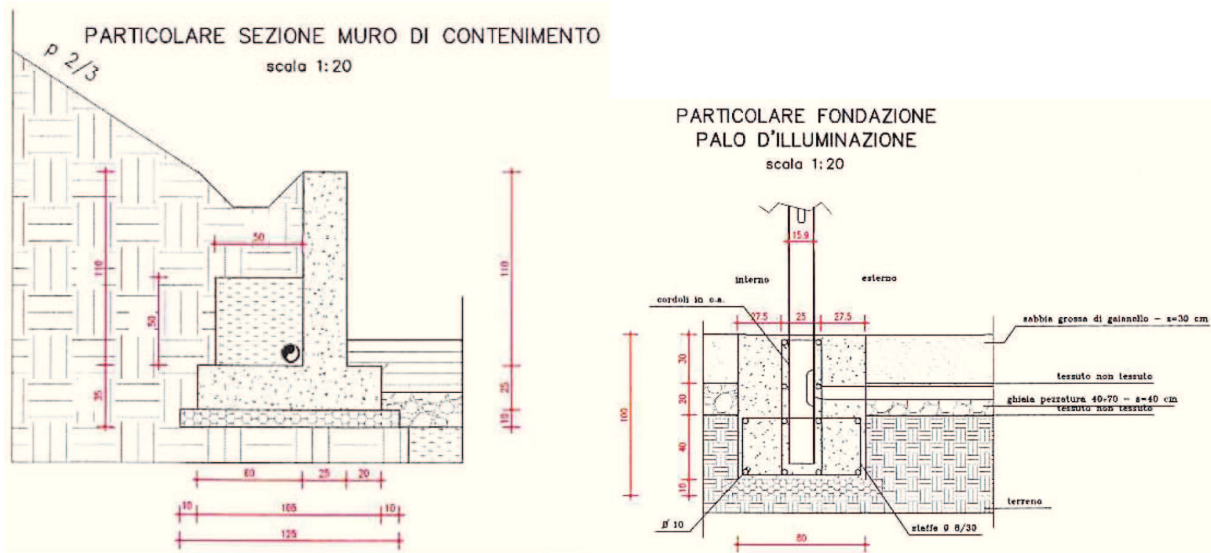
Particolari costruttivi di progetto del muro di contenimento e della fondazione dei pali d'illuminazione.
